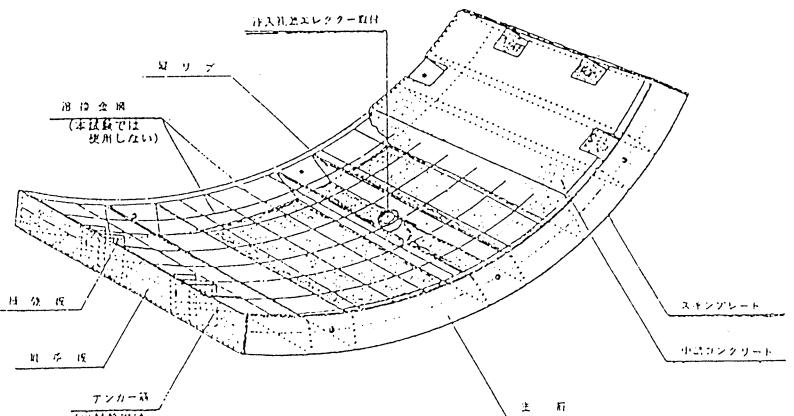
コンクリート中詰め鋼製セグメント鳥瞰図
